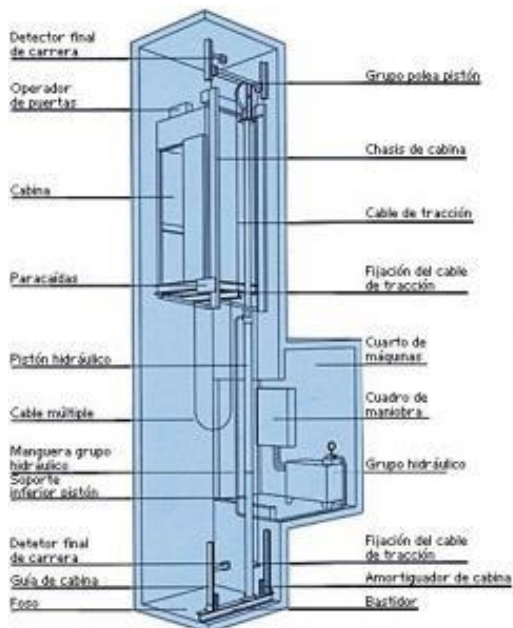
Detalle de los elementos del ascensor hidráulico.
